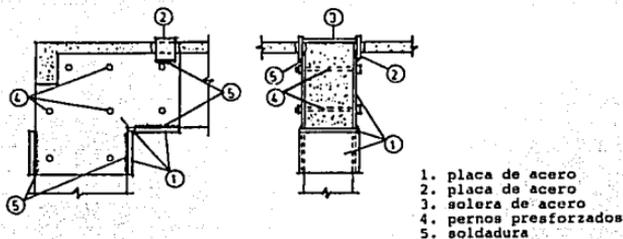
Encamisado metálico de una unión viga-columna.
